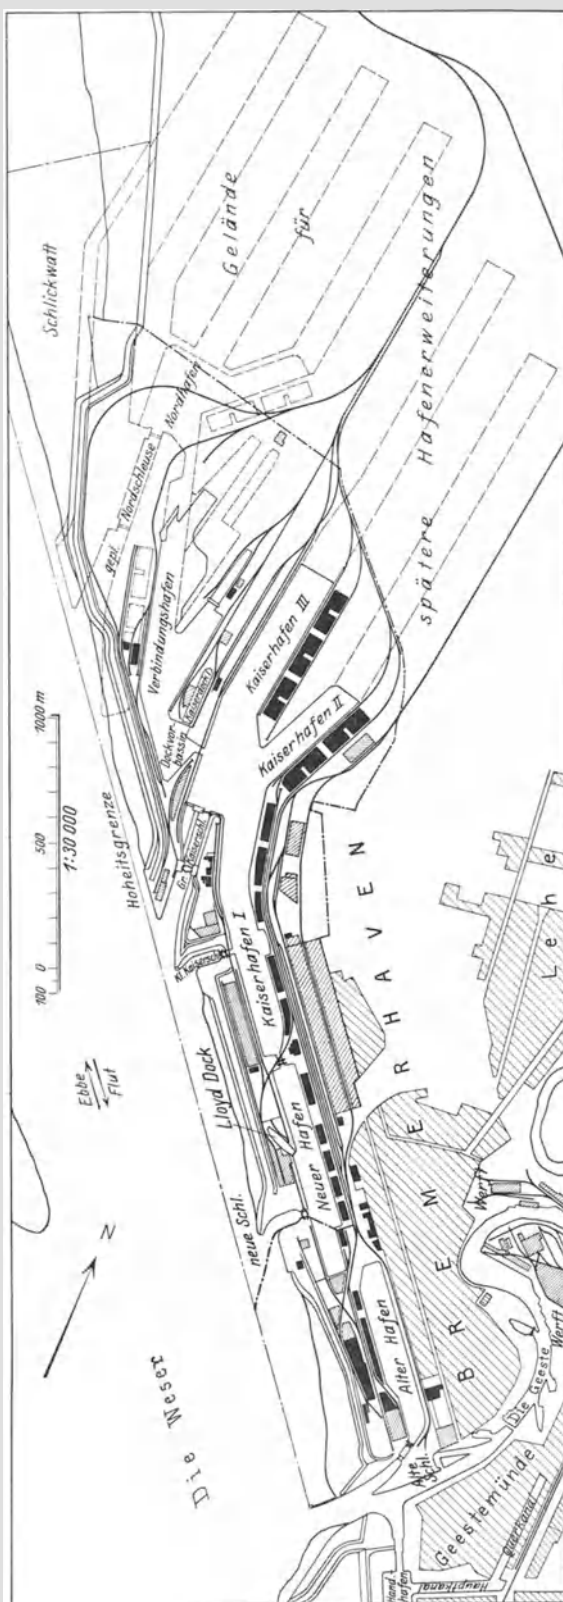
Hafenanlagen von Bremerhaven mit geplanten Erweiterungen. Flußmündungshafen. Dockhafen. Flutwechsel im Mittel 3,3 m; Höchstwert 9,3 m. Vorhafen von Bremen. Hauptwindrichtung: SW. Maßstab 1 : 30 000.
